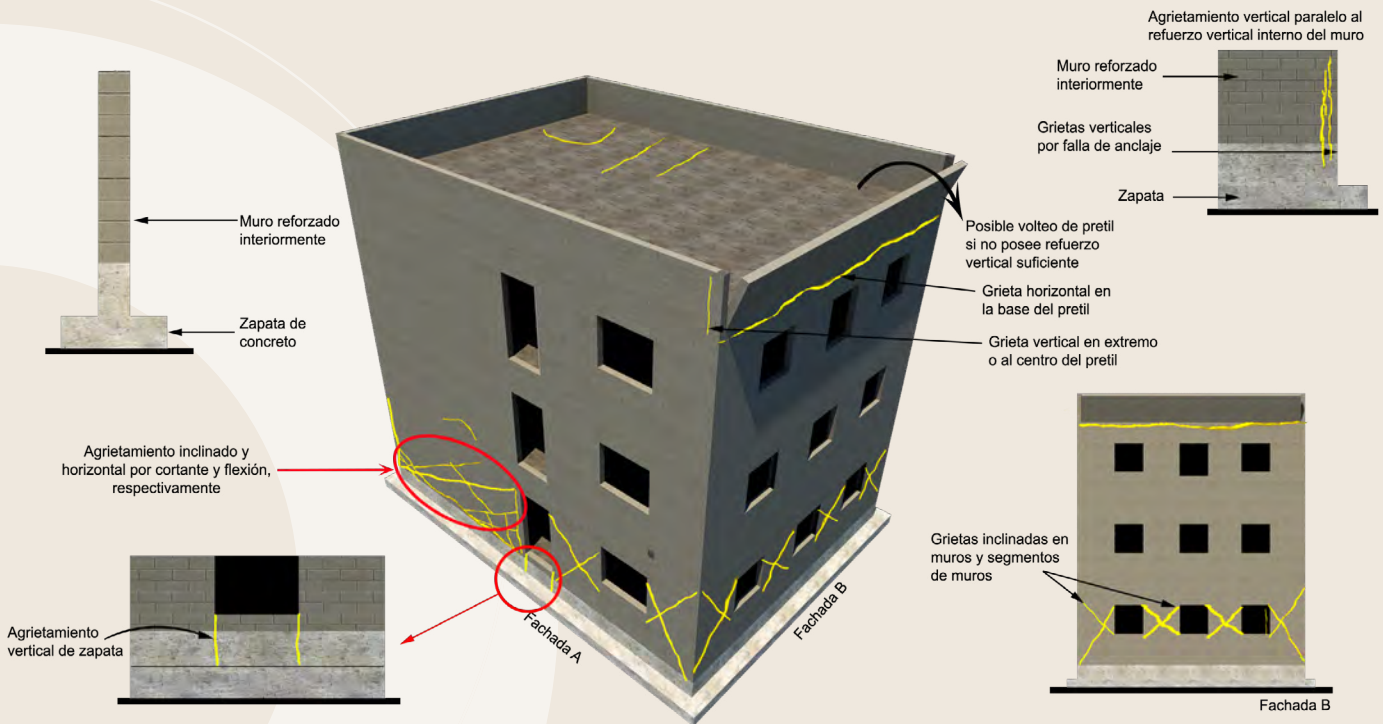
Modos de comportamiento en una construcción idealizada de mampostería reforzada interiormente. Fuente: elaboración propia.
